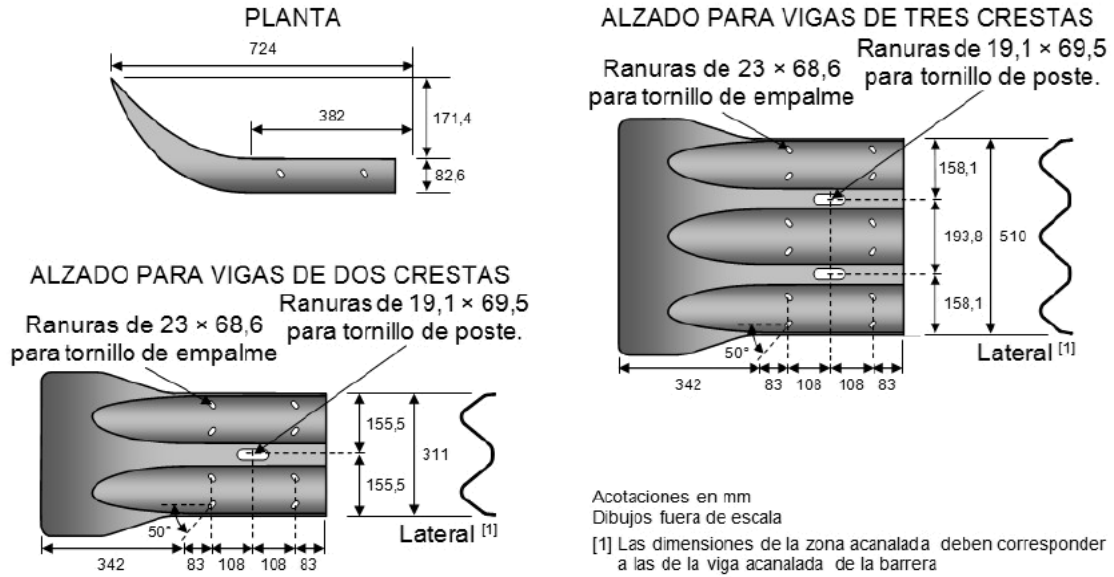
Secciones terminales sencillas para vigas acanaladas de dos y de tres crestas (OD-4.4.2/S)
